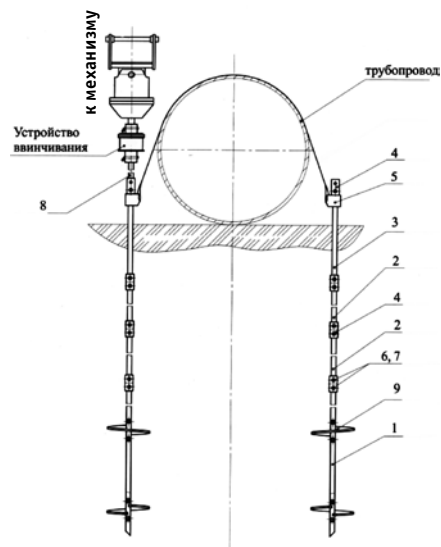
Винтовое анкерное устройство для закрепления трубопроводов: 1 – стержень с установленными винтовыми лопастями (винтовой анкер); 2, 3 – дополнительные удлинительные стержни; 4 – муфта соединительная; 5 – силовой пояс; 6, 7 – болт, гайка; 8 – технологический стержень (стержень для доворачивания); 9 – винтовая лопасть (центрирующая); 10 – винтовая лопасть (несущая)
